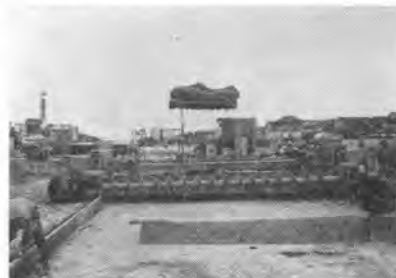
鳴尾舗装(直営)コンクリートフィニッシャー
